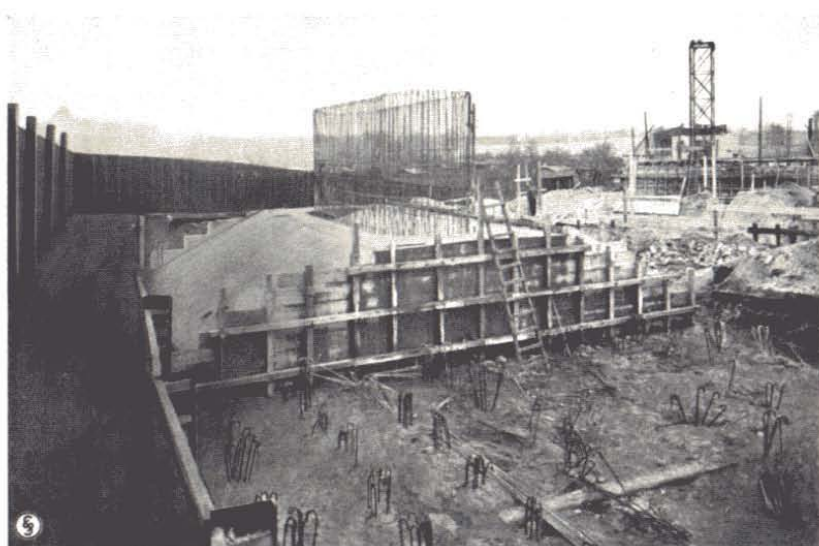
Nordpfeiler am Siemensdamm: Pfahlkopfbewehrung, betonierte hintere Hälfte der Fundamentplatte mit Bewehrung des aufgehenden Pfeilers
